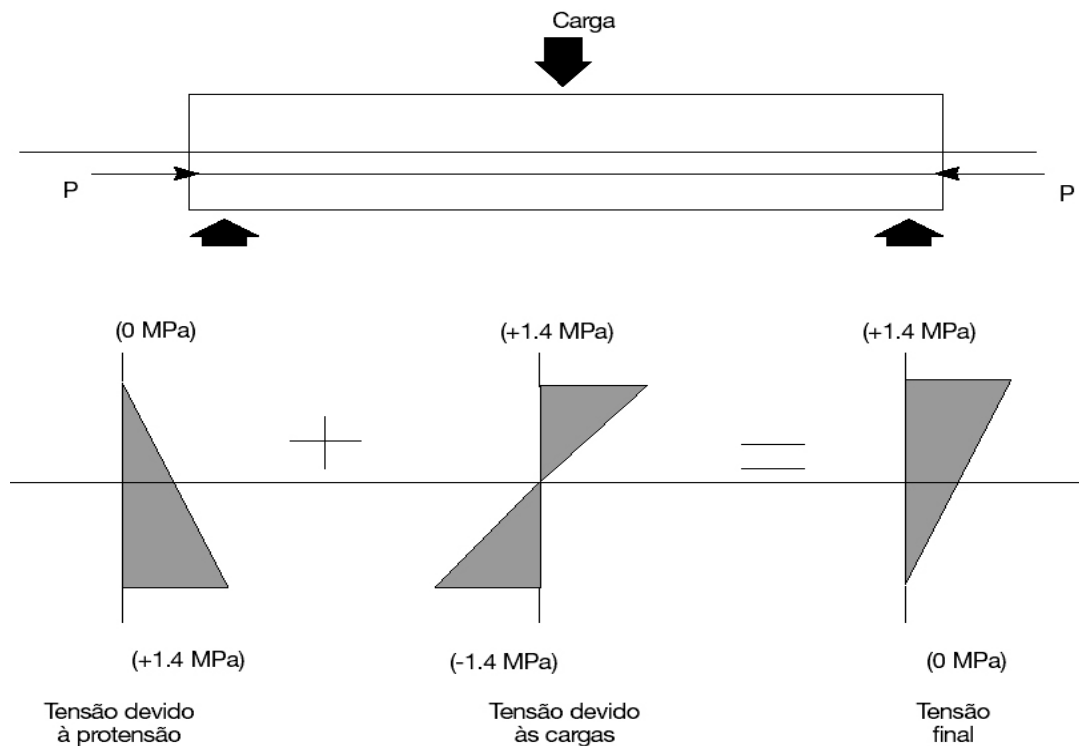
Distribuição das tensões em uma viga protendida.
